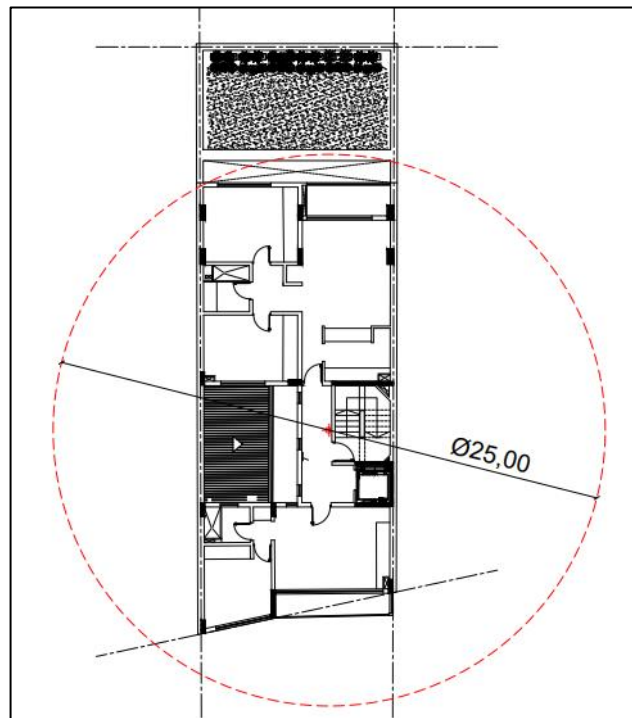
Ubicación y alcance de hidrantes en planta tipo.
